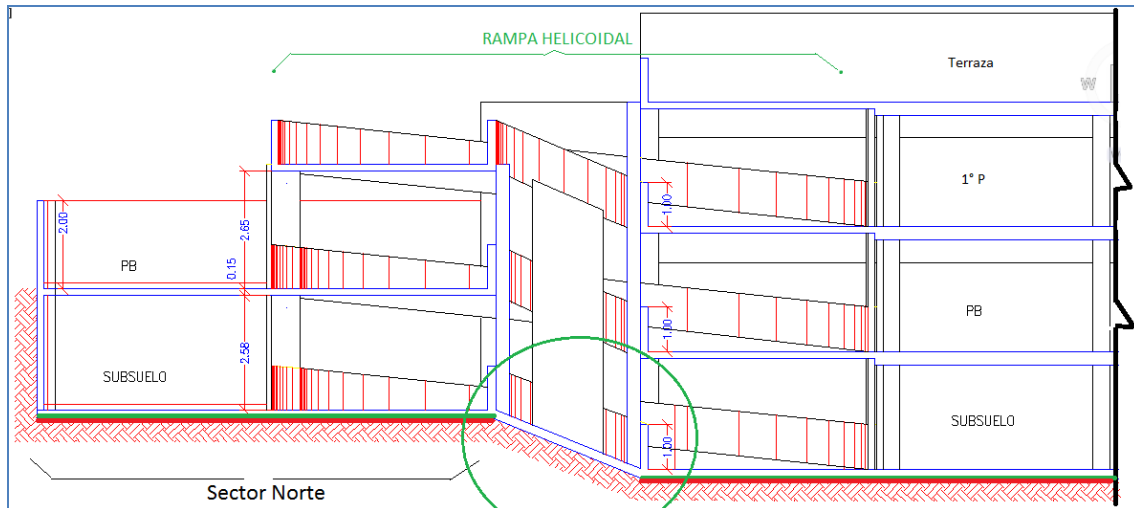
Corte longitudinal del edificio de cocheras en donde se advierte los desniveles entre los sectores norte y sur.
